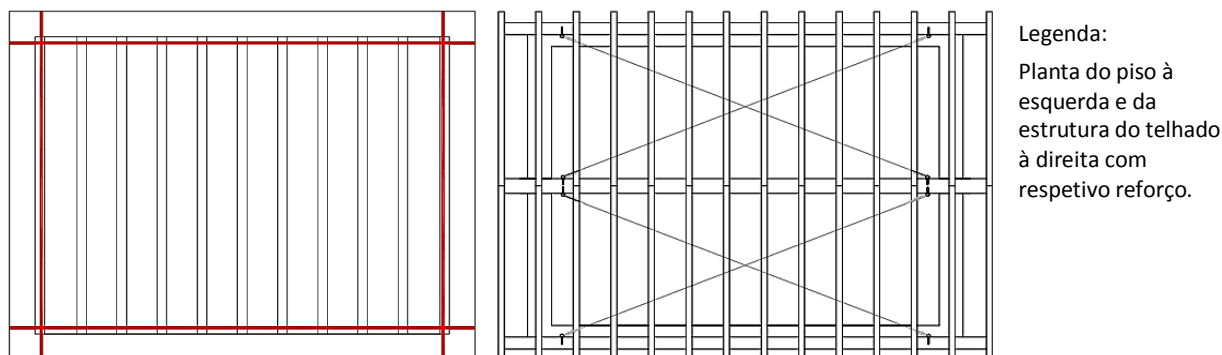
Planta do piso e da estrutura do telhado com indicação de tirantes (vermelho) e de cabos de contraventamento adotado. Fonte: [75].
